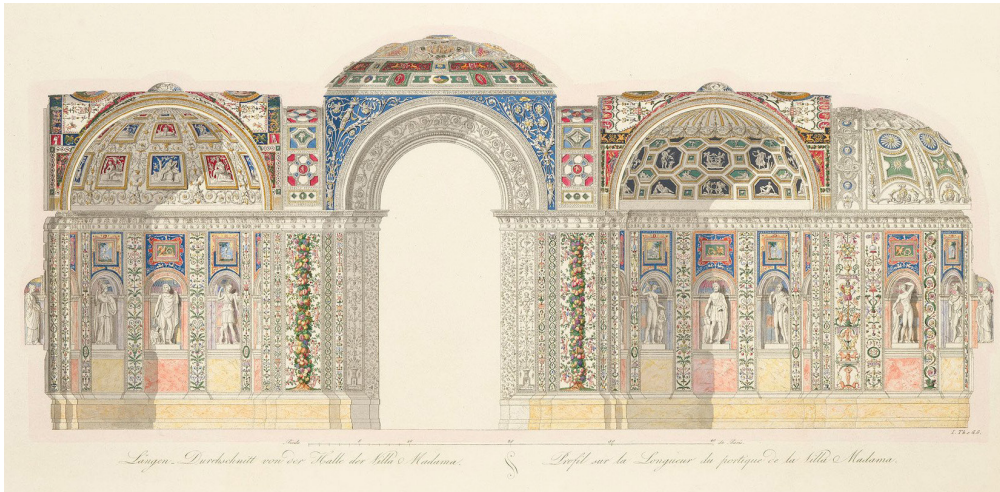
Vista de la *loggia* pompeyana de Villa Madama, con su decoración pictórica. Fuente: Joseph Thürmer (1789-1833), *A longitudinal section of the Loggia of Villa Madama*, publicado en Gruner 1844. Cromolithografía. Royal Collection Trust. Prince Albert. Ref. web 7.
